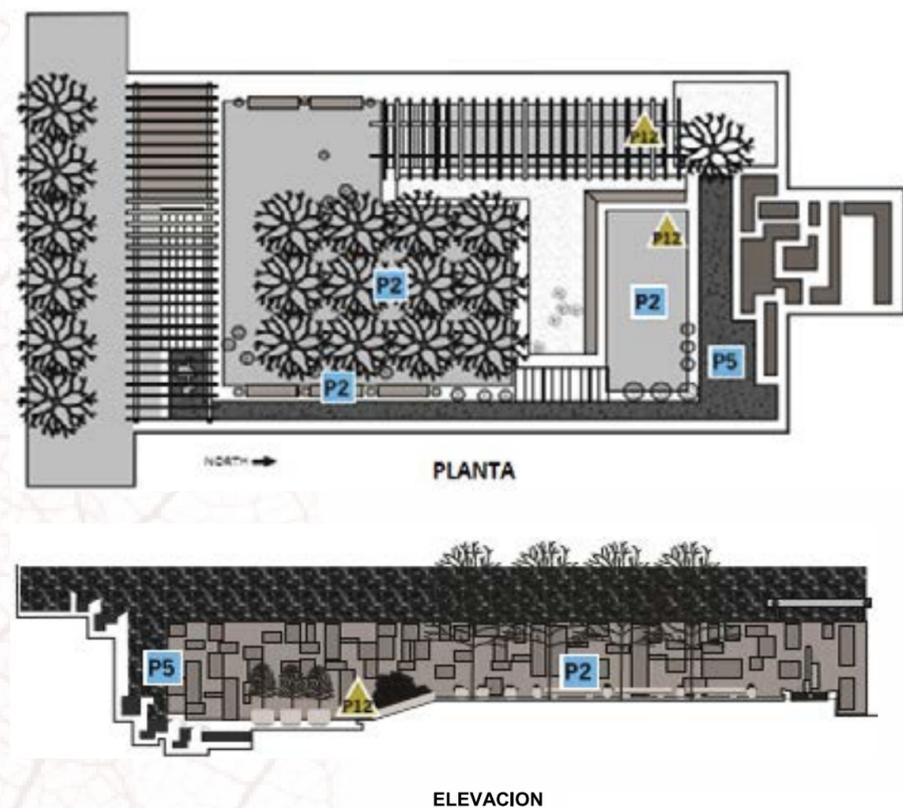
Planta y Elevación elaborado por Terrapin Bright Green
